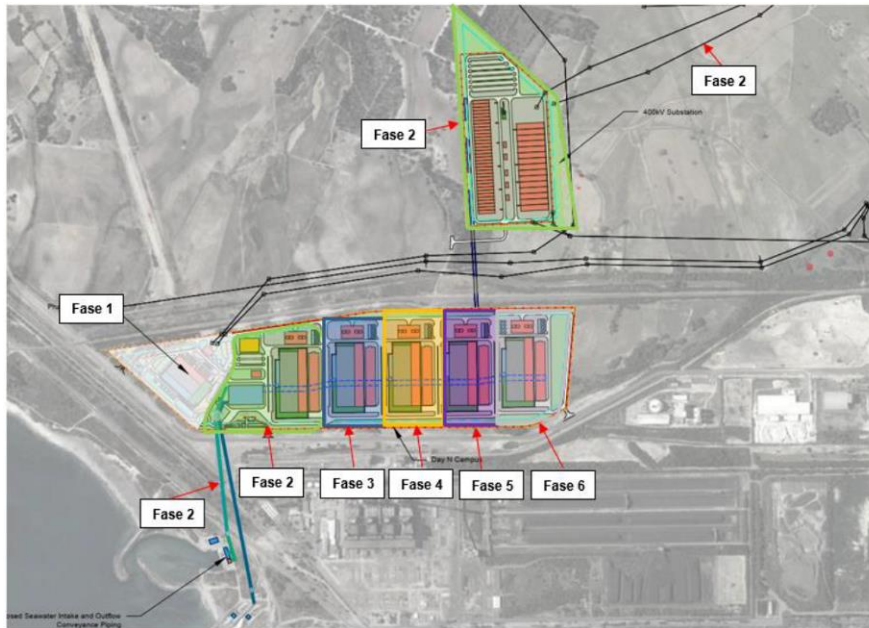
Esquema Geral do Projeto SIN02-06 – Fases de Construção. Fonte: RS
